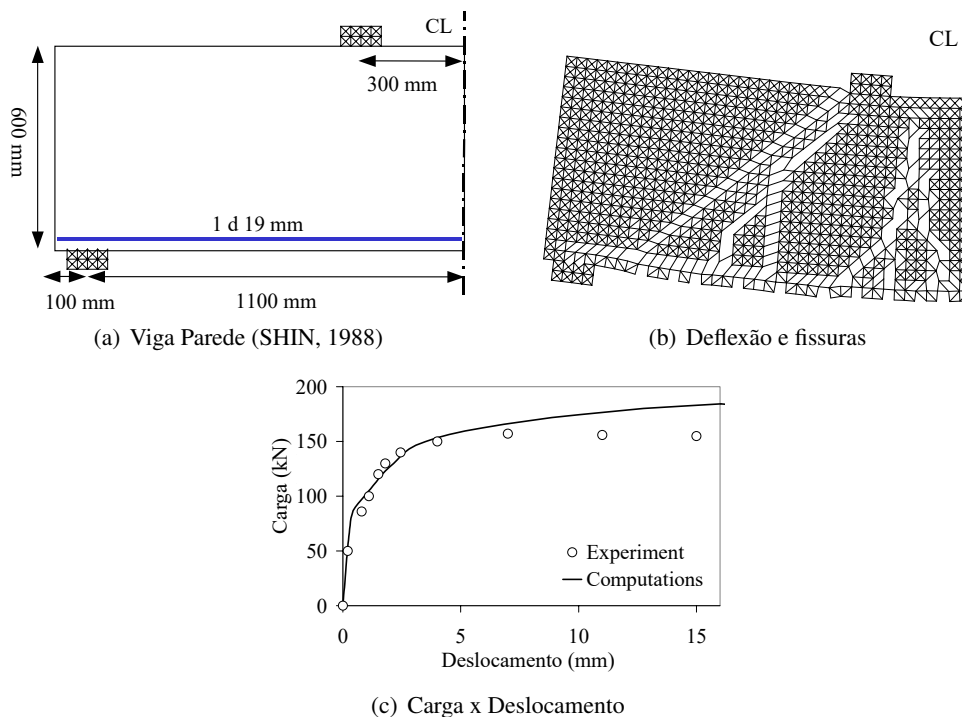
Aplicação do MMT em viga por Salem (2004)
